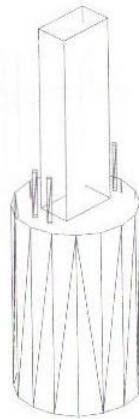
Detalhe da implantação do pilar na estaca e esperas para vigas baldrames
